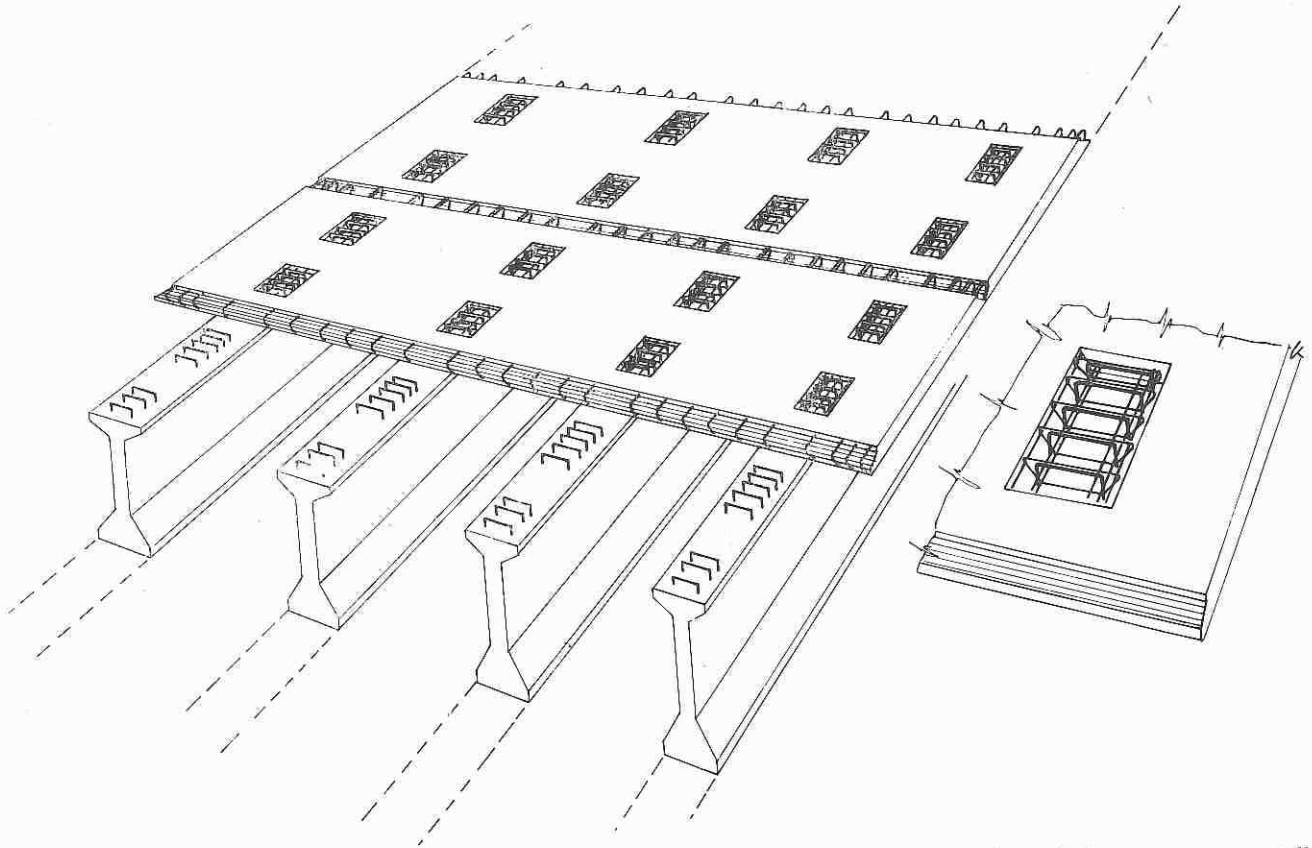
Schema prospettico delle lastre prefabbricate disposte sulle travi e particolare delle armature metalliche interessanti un vano.
